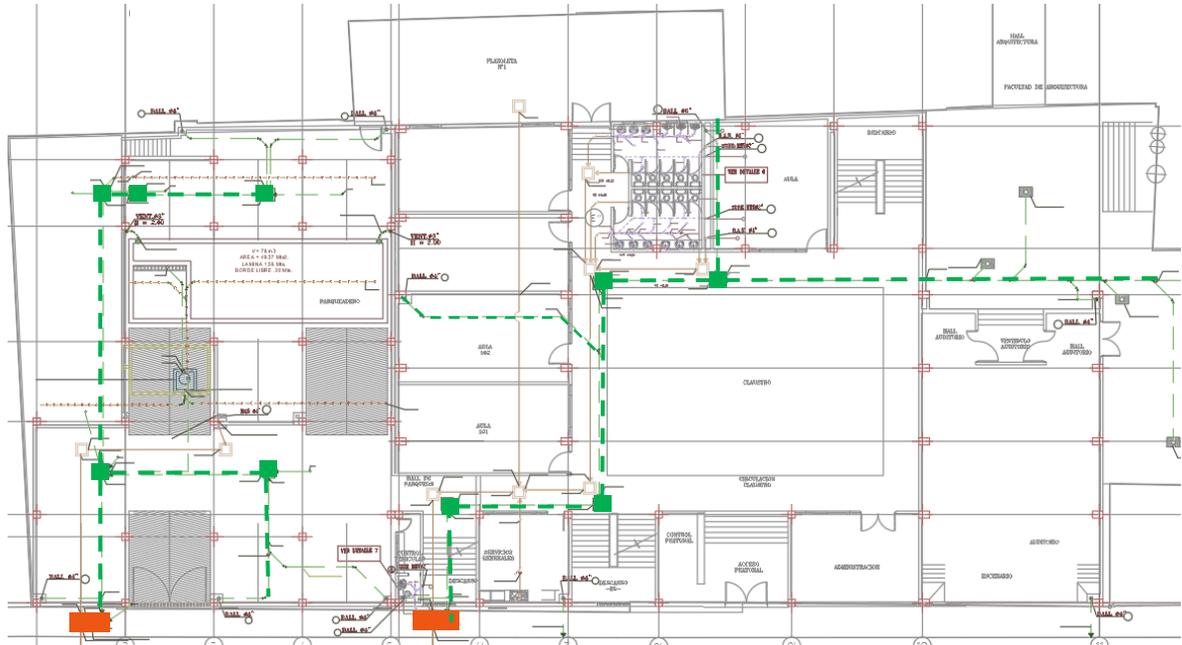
cajas de inspección, Adaptado de planimetría del bloque I
